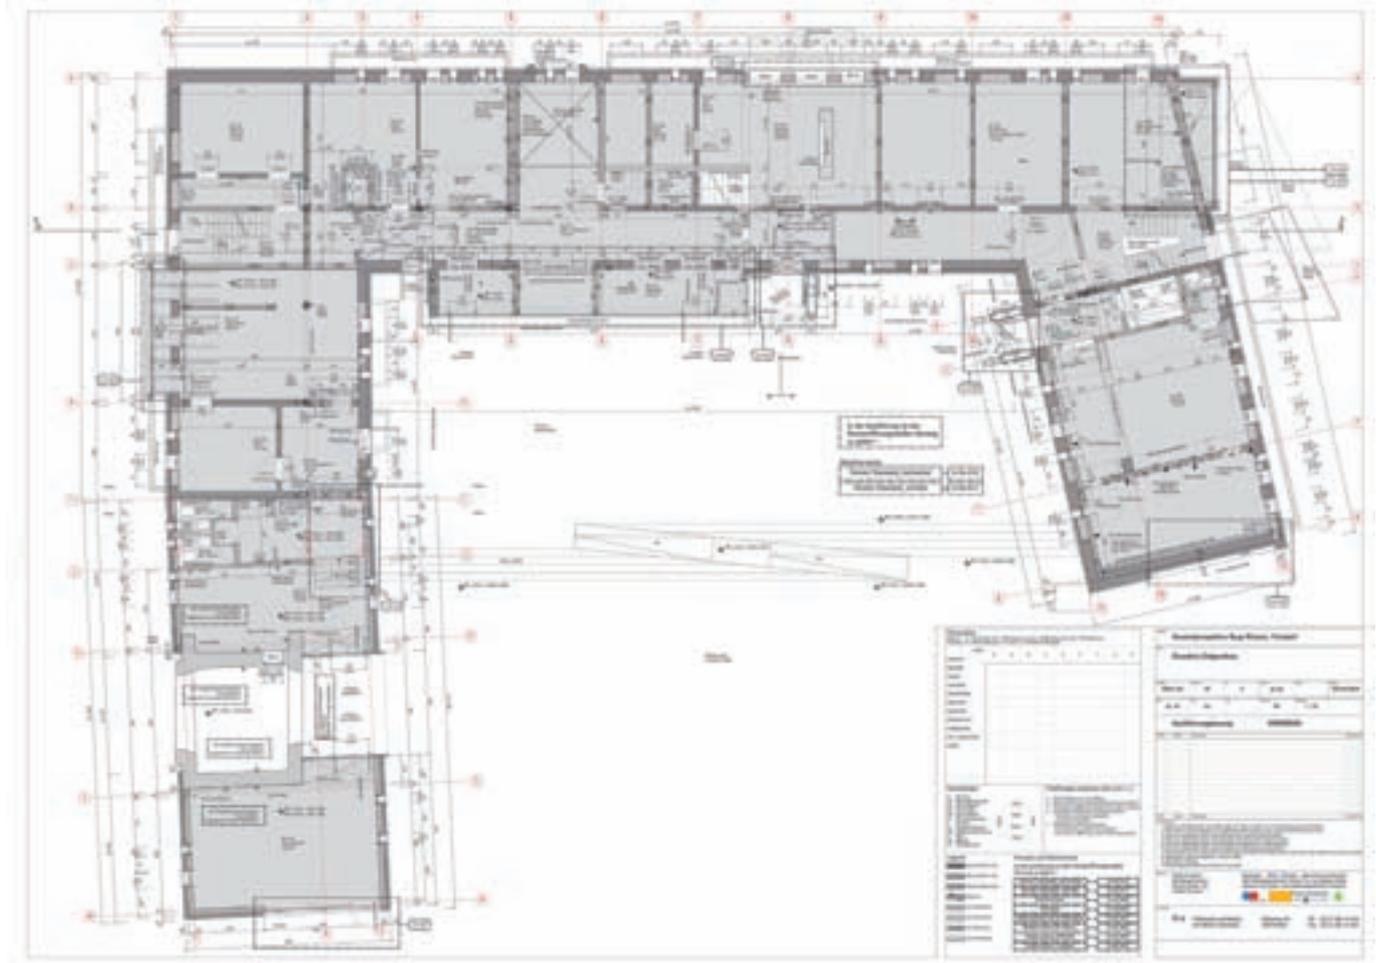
Grundriss Burg Wissem (hillebrandt architektur mit Martin Schneider)
